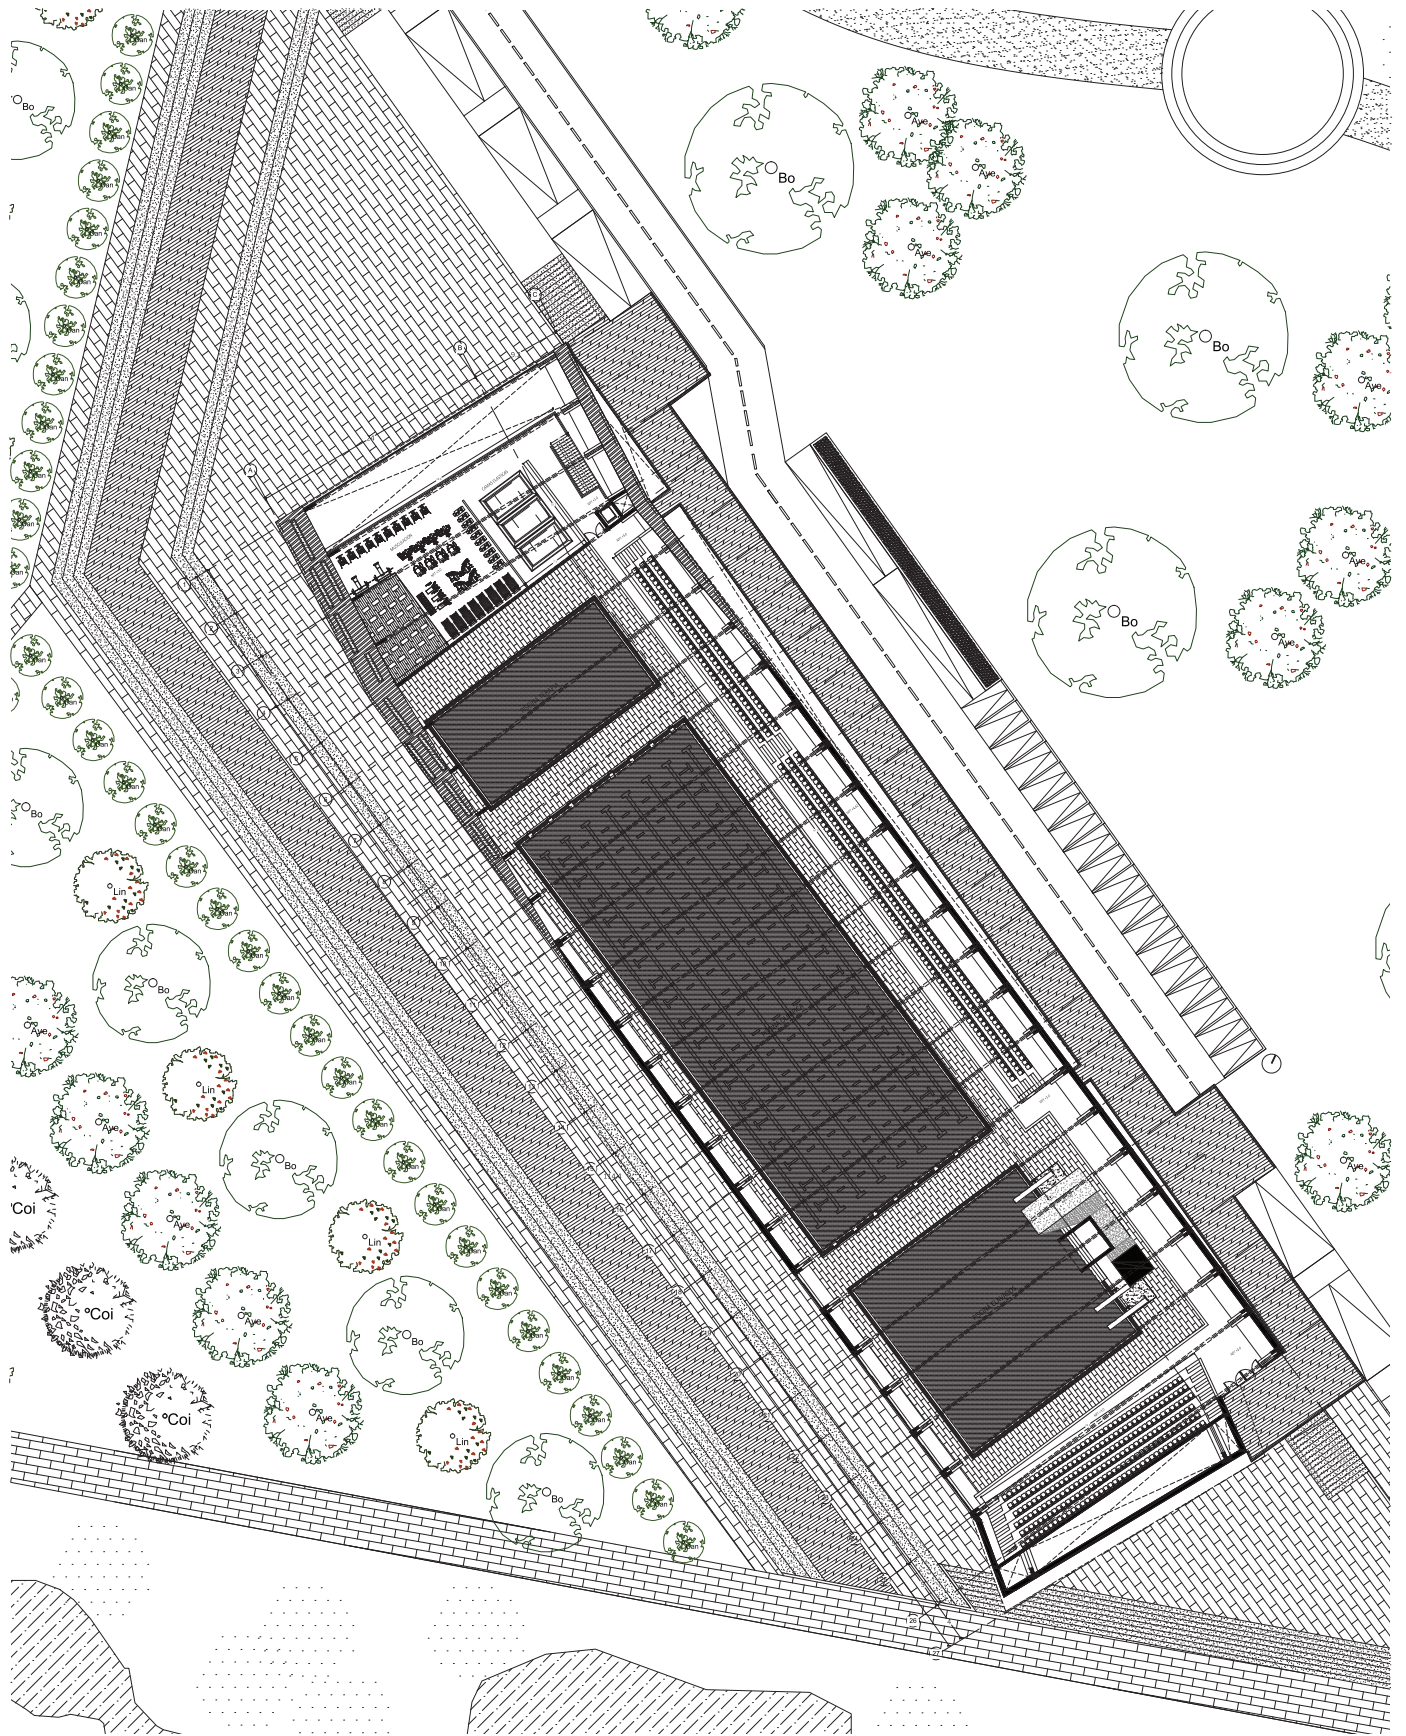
\_ Planta Centro Acuatico NPT+3.0 1:1200
